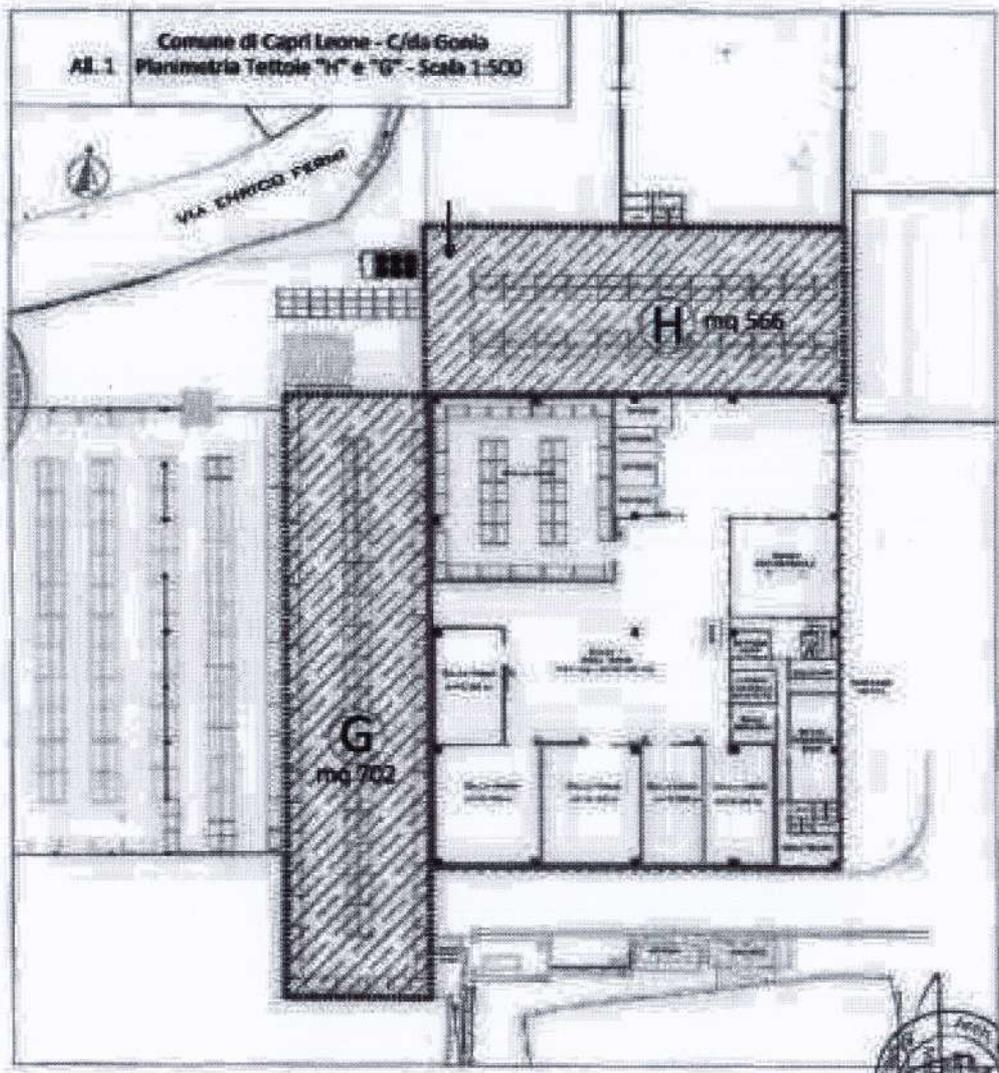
Planimetria con individuazione delle due tettoie tecnologiche H e G
